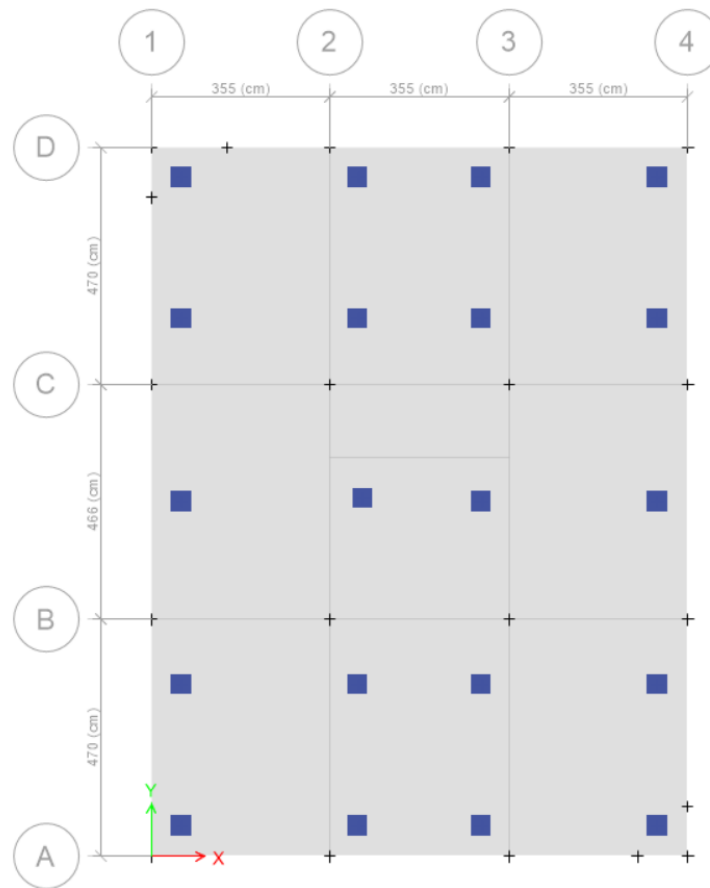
Definición de pilotes de 0.40m x 0.40m
